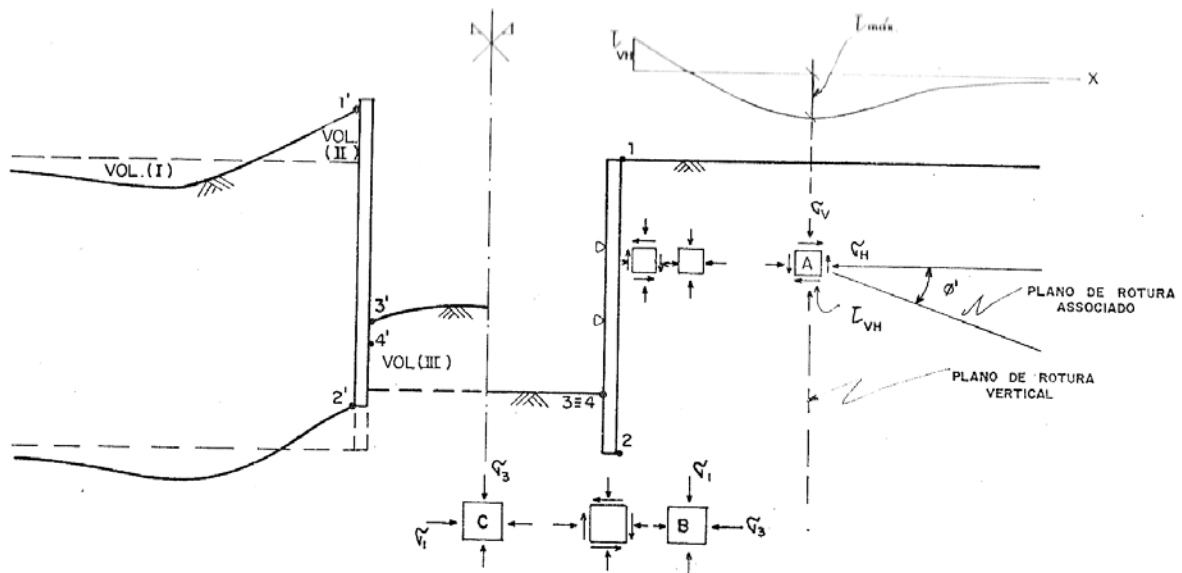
Estado de tensões e deformações no solo em uma escavação escorada em processo de ruptura de fundo, Ehrlich (1987)
